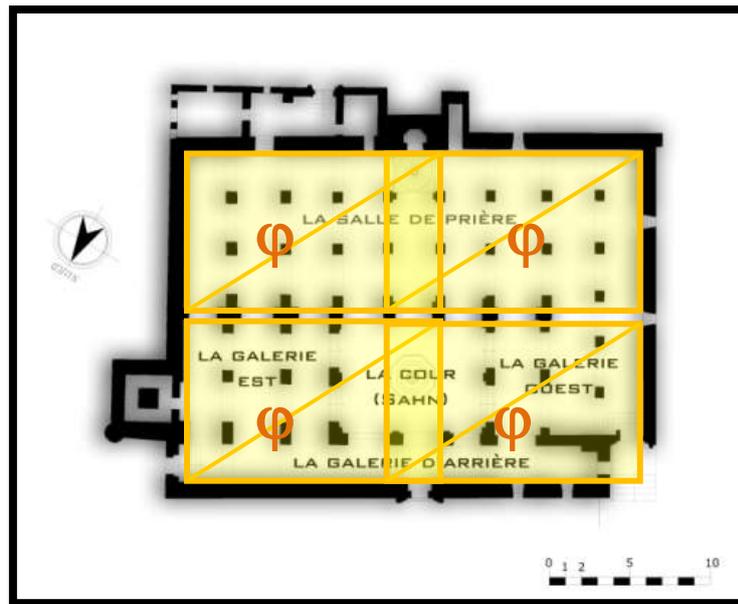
le recouvrement du plan par quatre rectangles d'or.
